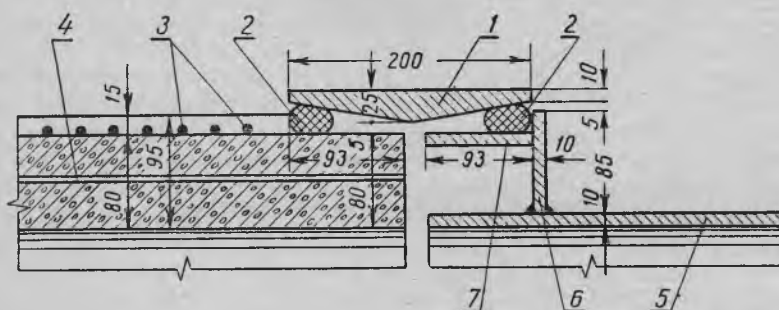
Муфтовый стык соединения предварительно напряженного железобетонного и стального трубопроводов:
